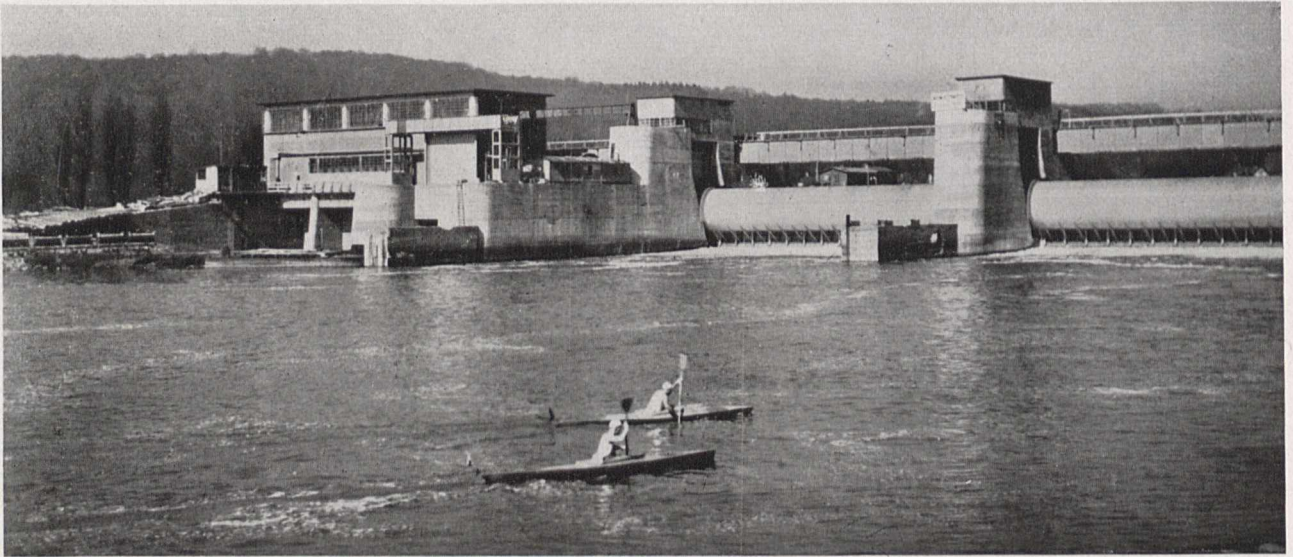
Stauanlage mit dem Krafthaus bei Werden
